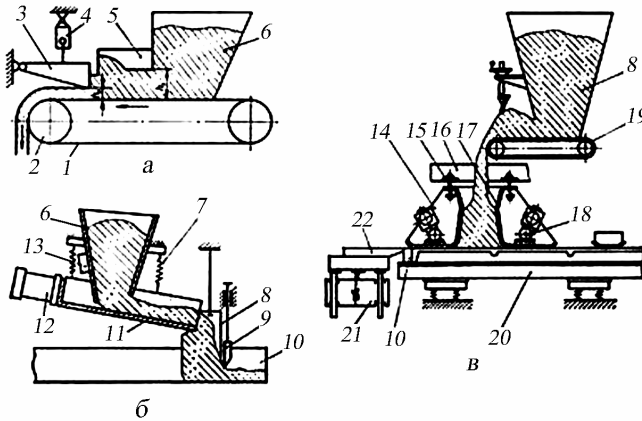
Схеми живильників бетоноукладачів:
